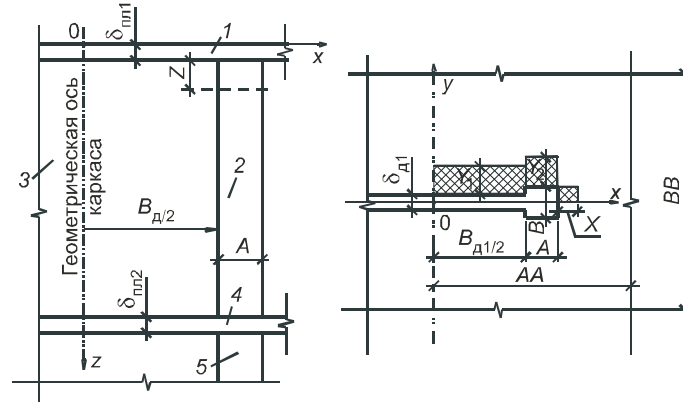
Расчетная схема теплового сопряжения бетонируемой плиты перекрытия с ранее забетонированными колоннами и диафрагмами
